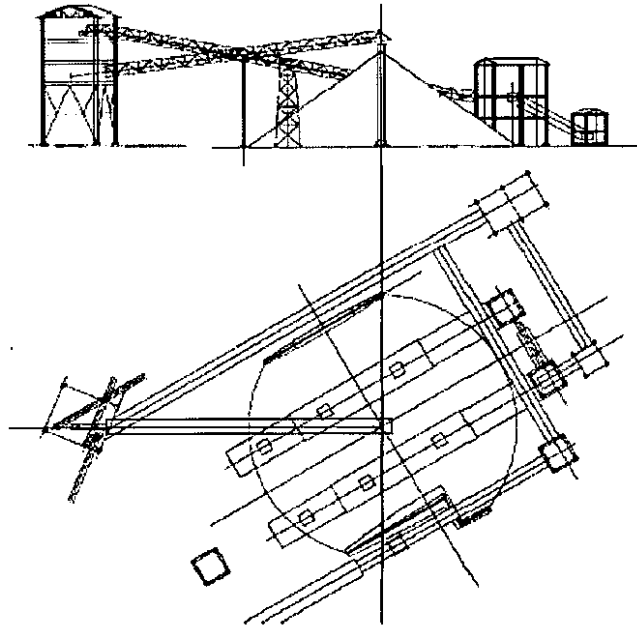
c Pianta e vista del parco Agglomerato Nord
